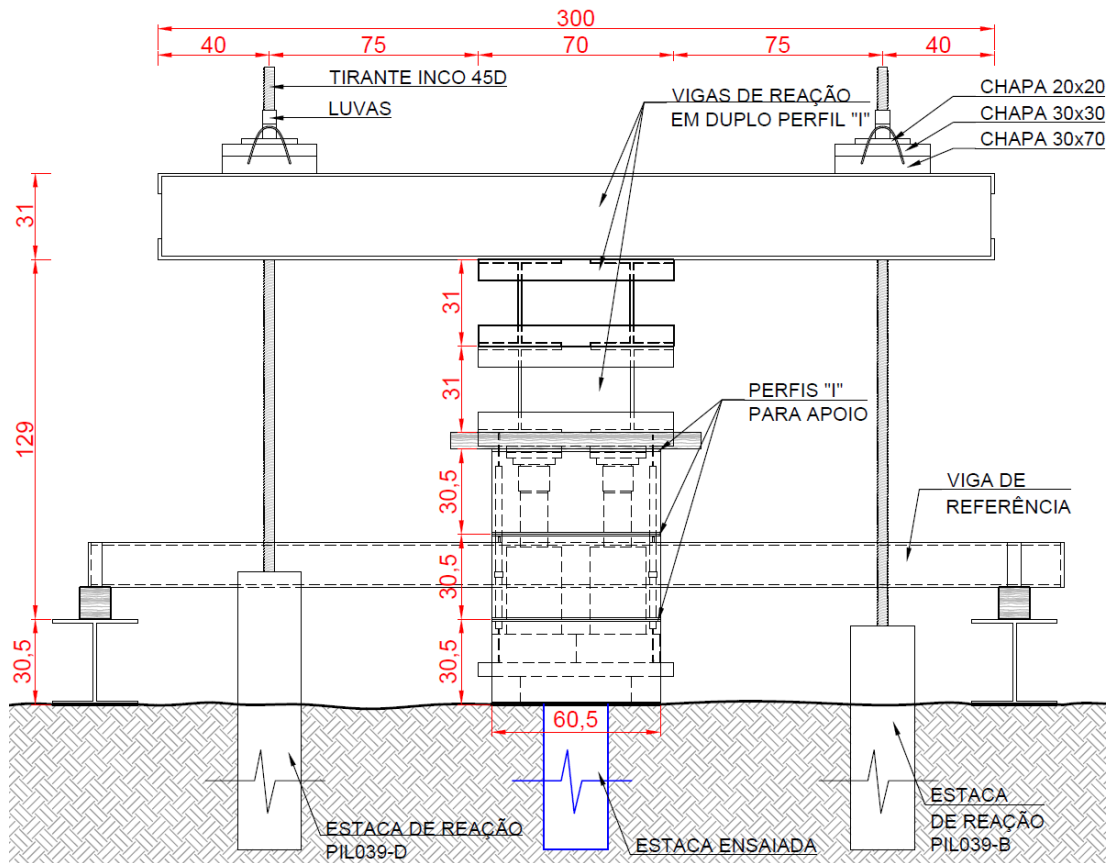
Vista lateral do sistema montado para execução da prova de carga.
